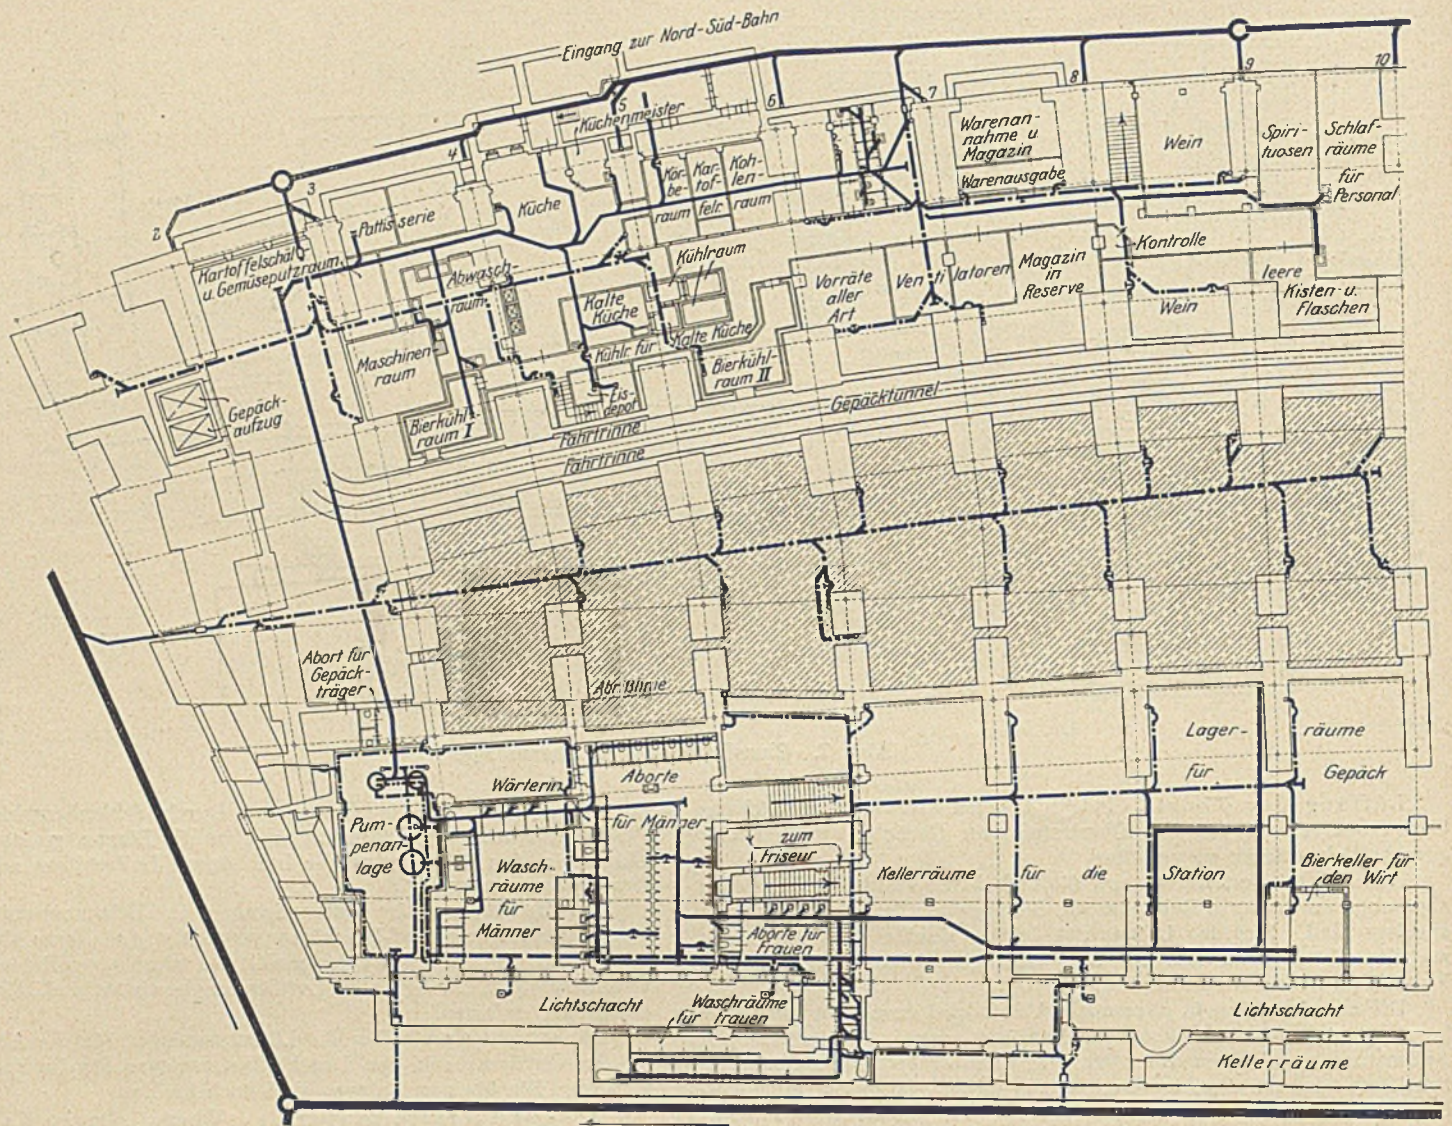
Übersichtsplan der Entwässerungsanlage.
